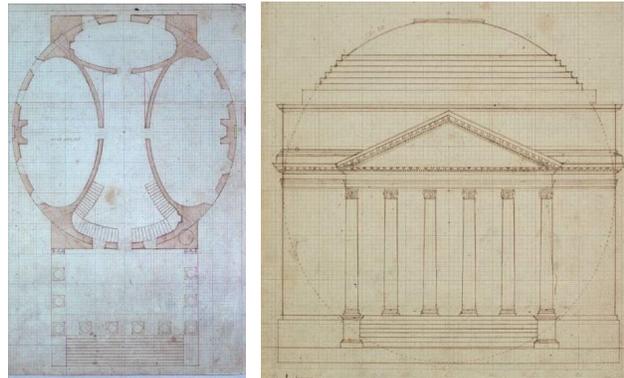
Planta do 1º Andar; Fig.: 88 – Fachada
